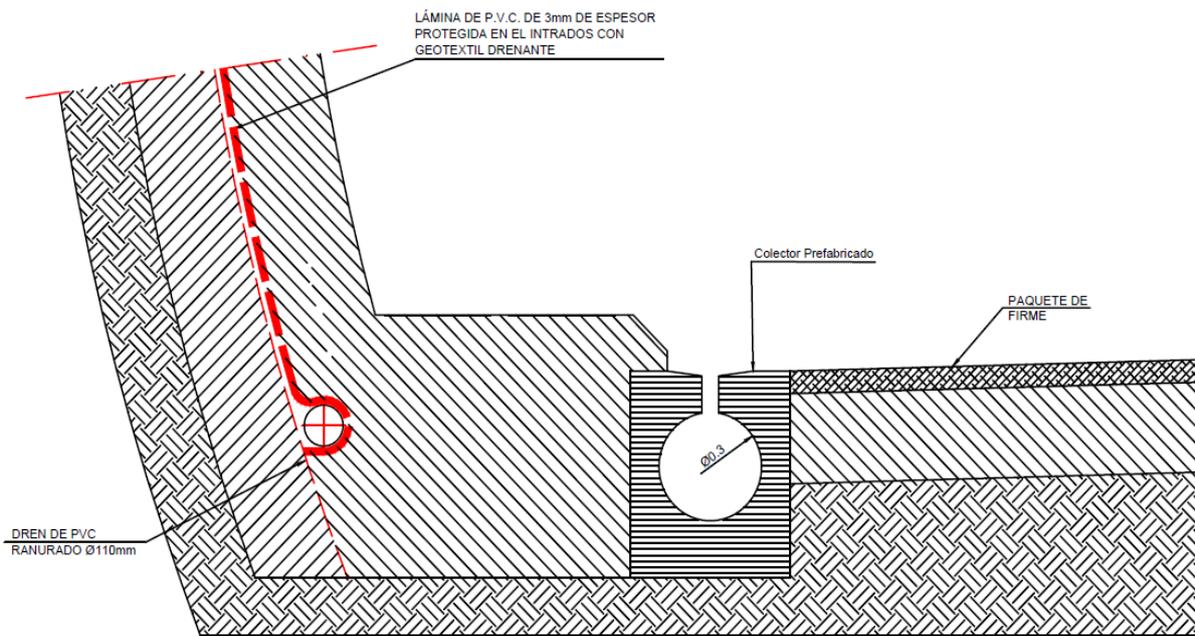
Detalle de la impermeabilización. Elabocacion Propia.
